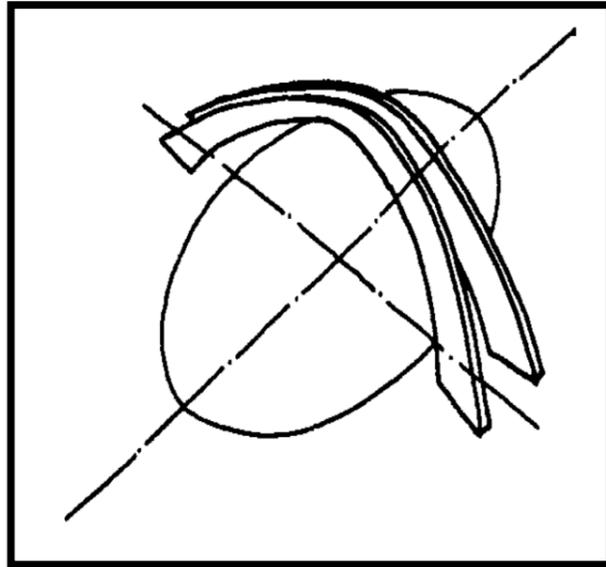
Arcos centrales de apoyo en la cubierta, Coliseo, Fuente: Comprensión de las estructuras en arquitectura
